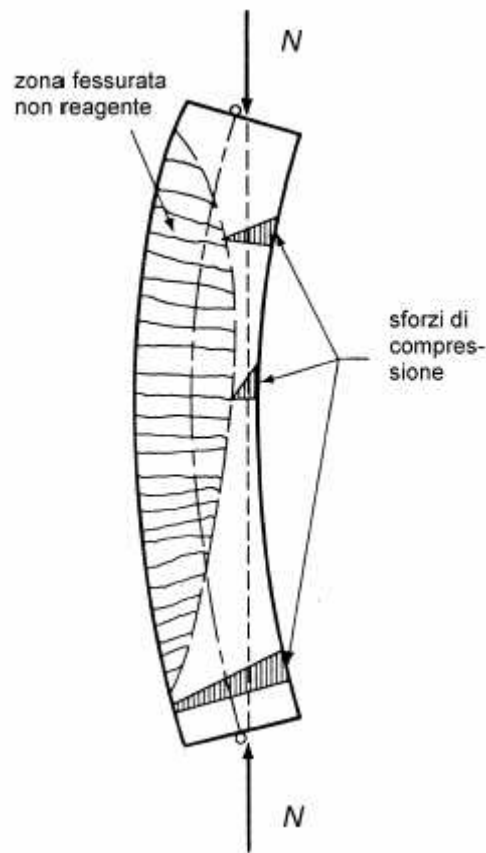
Distribuzione delle tensioni in funzione dell'eccentricità del carico nelle sezioni di una colonna di materiale elastico non reagente a trazione soggetta a compressione
